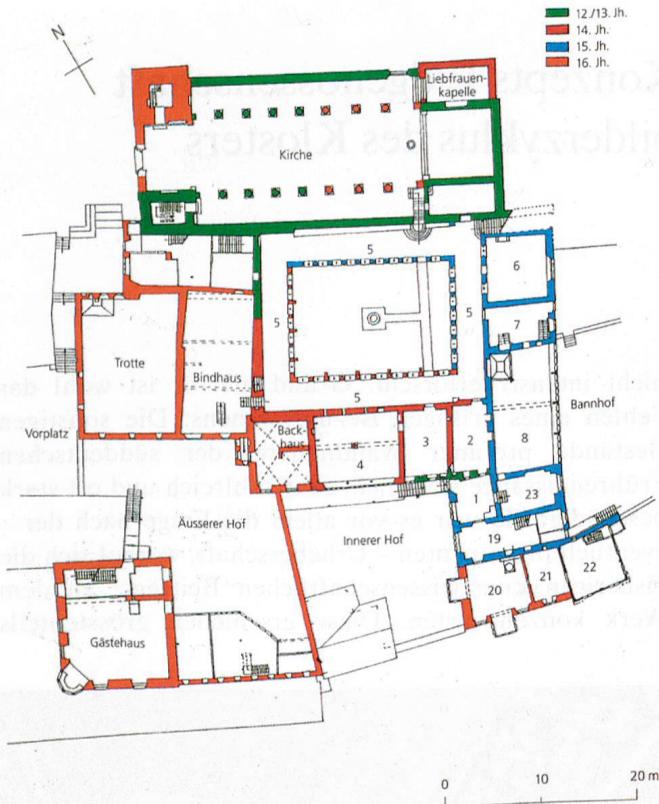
Erdgeschoss-Grundriss der gesamten Anlage des Klosters St. Georgen.
